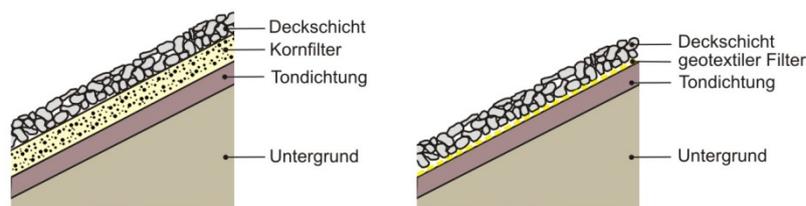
Deckwerksaufbau mit Tondichtung und Kornfilter (links) und geotextilem Filter (rechts)
